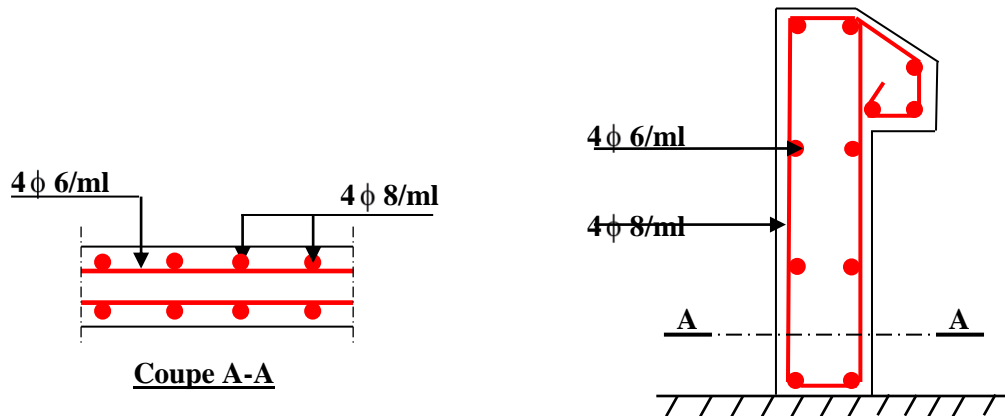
Schéma de ferrailage de l'acrotère (Terrasse inaccessible).
